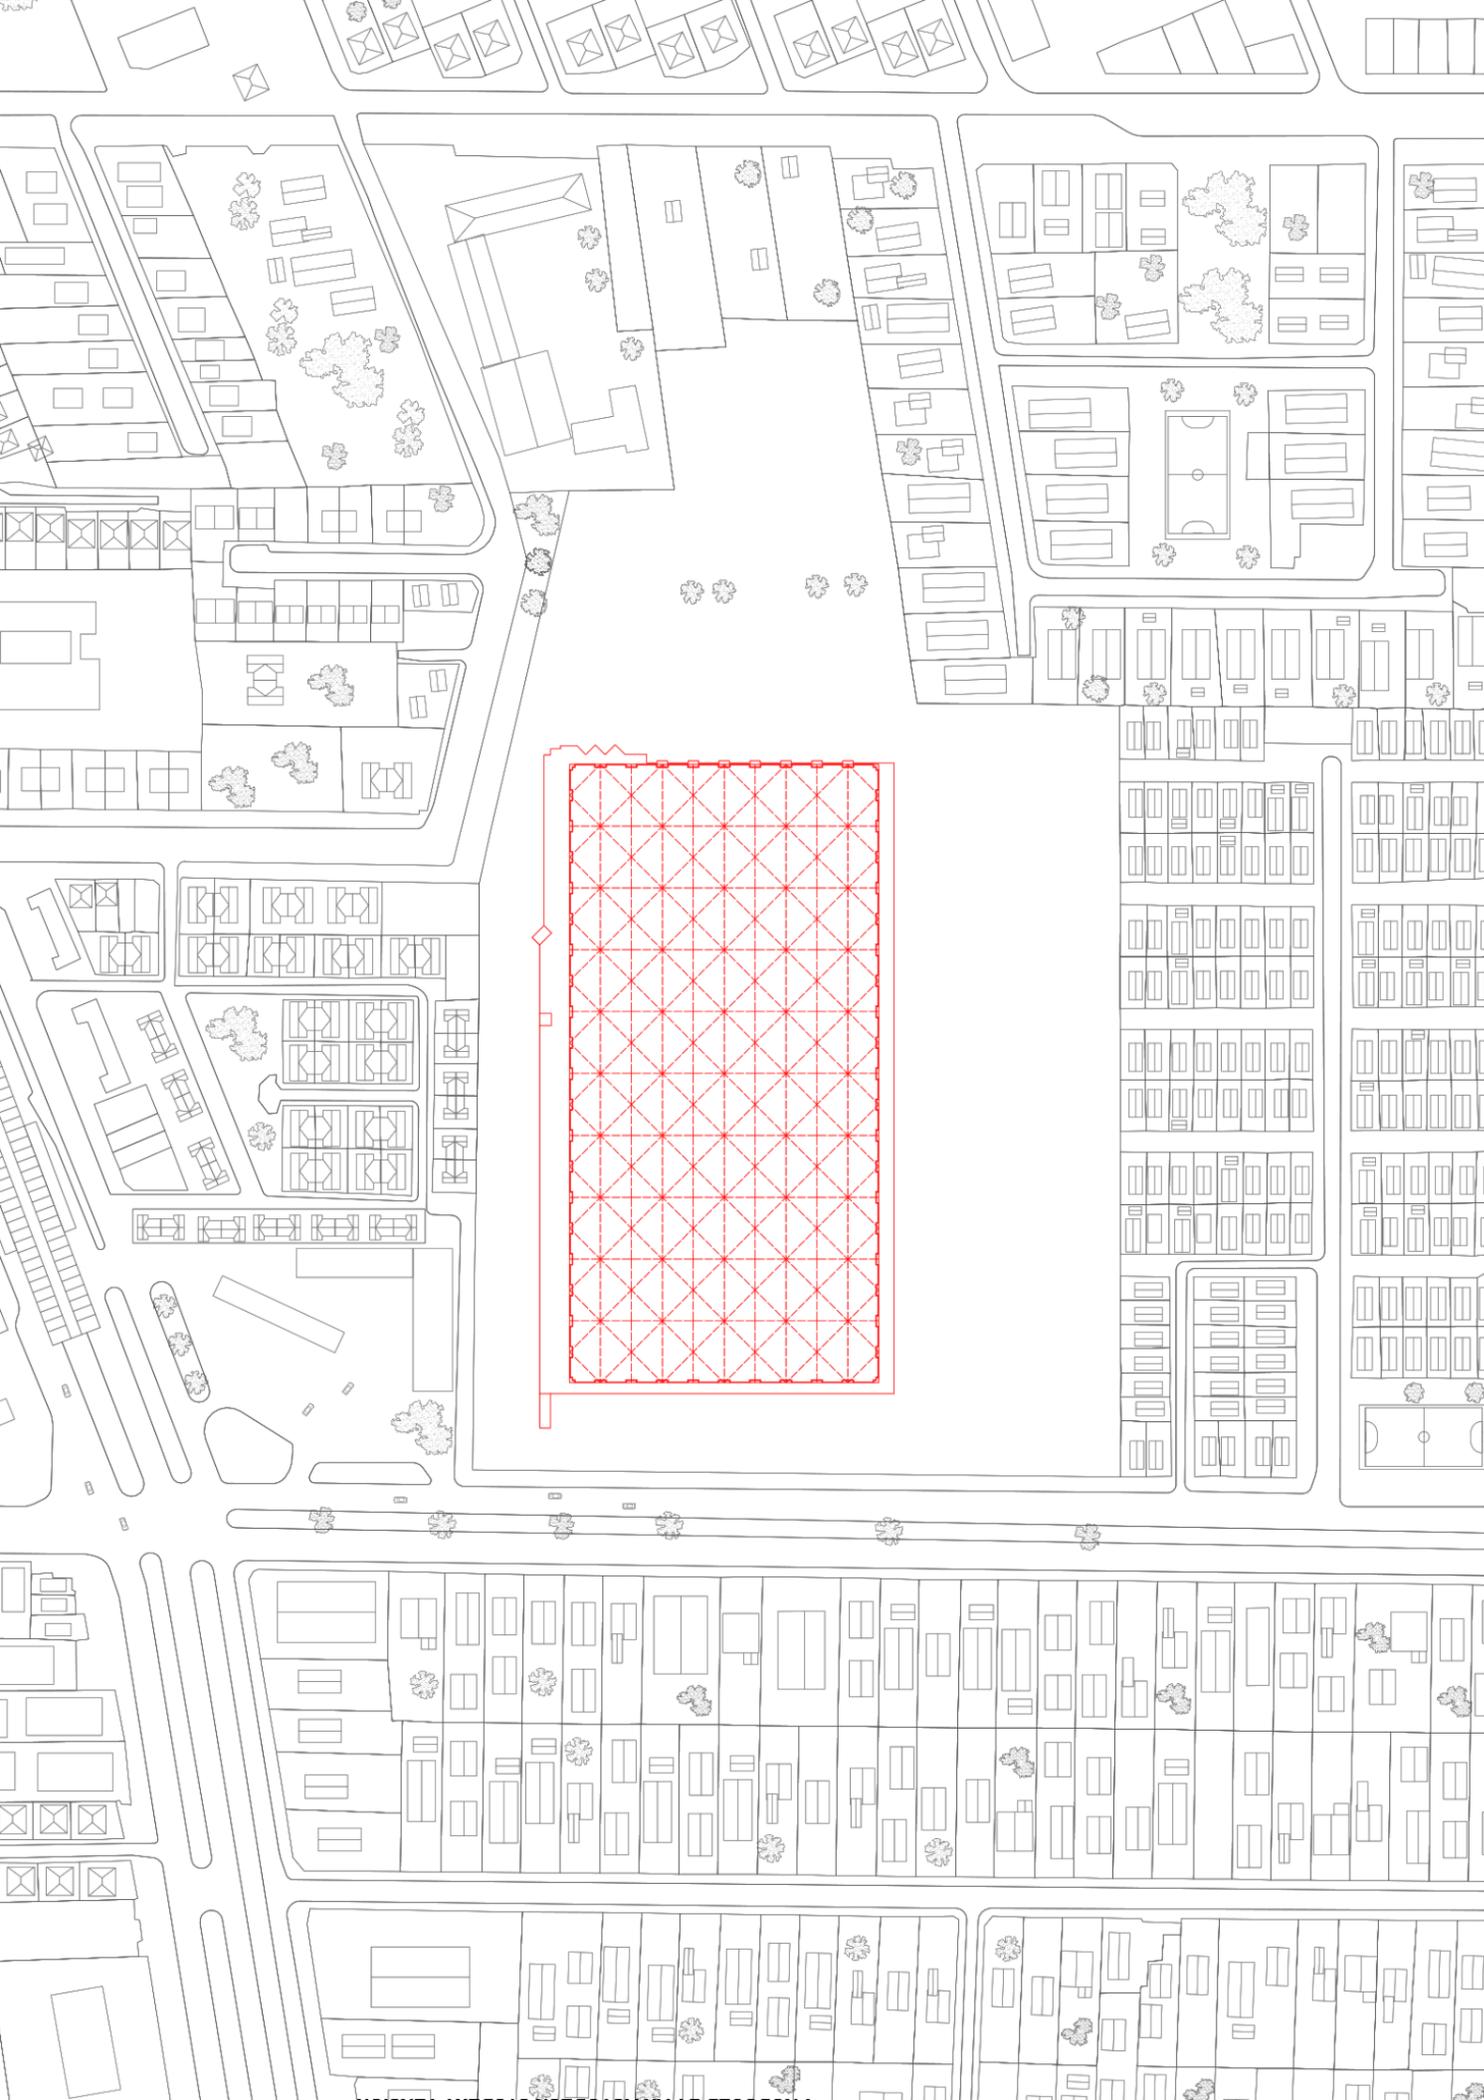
Elaboración Propia, Planta Emplazamiento galpón principal
